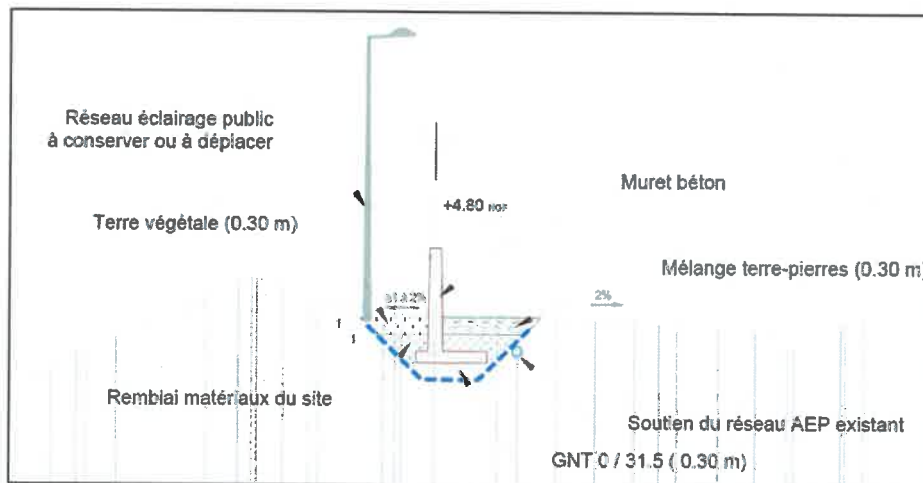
Coupe type muret en béton (source: dossier du pétitionnaire)
